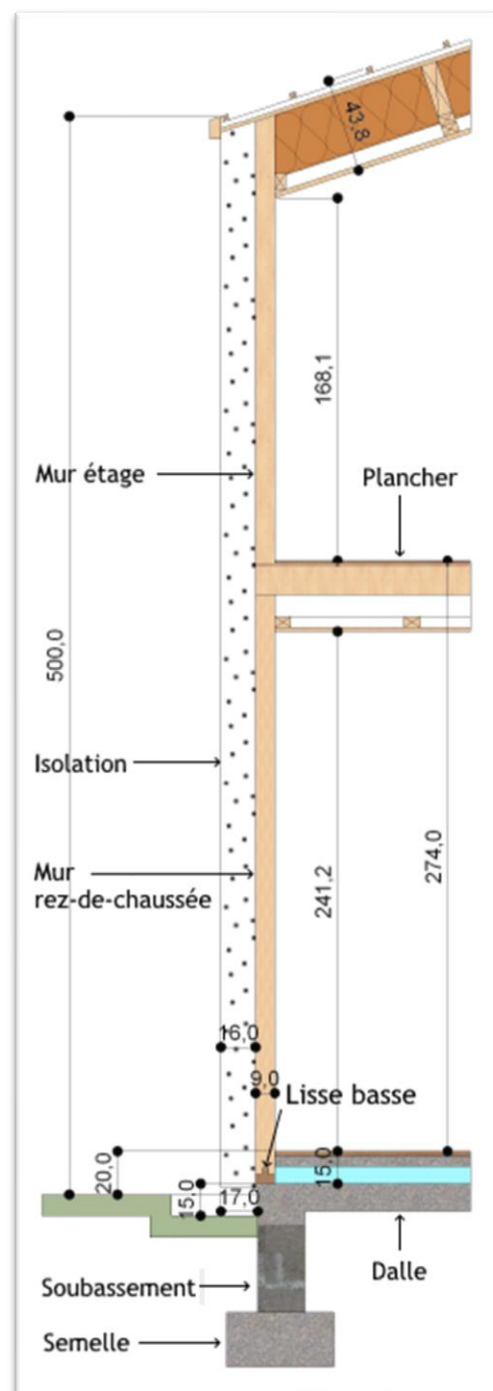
Coupe type d'une construction [unité : cm], source C. Launeau
